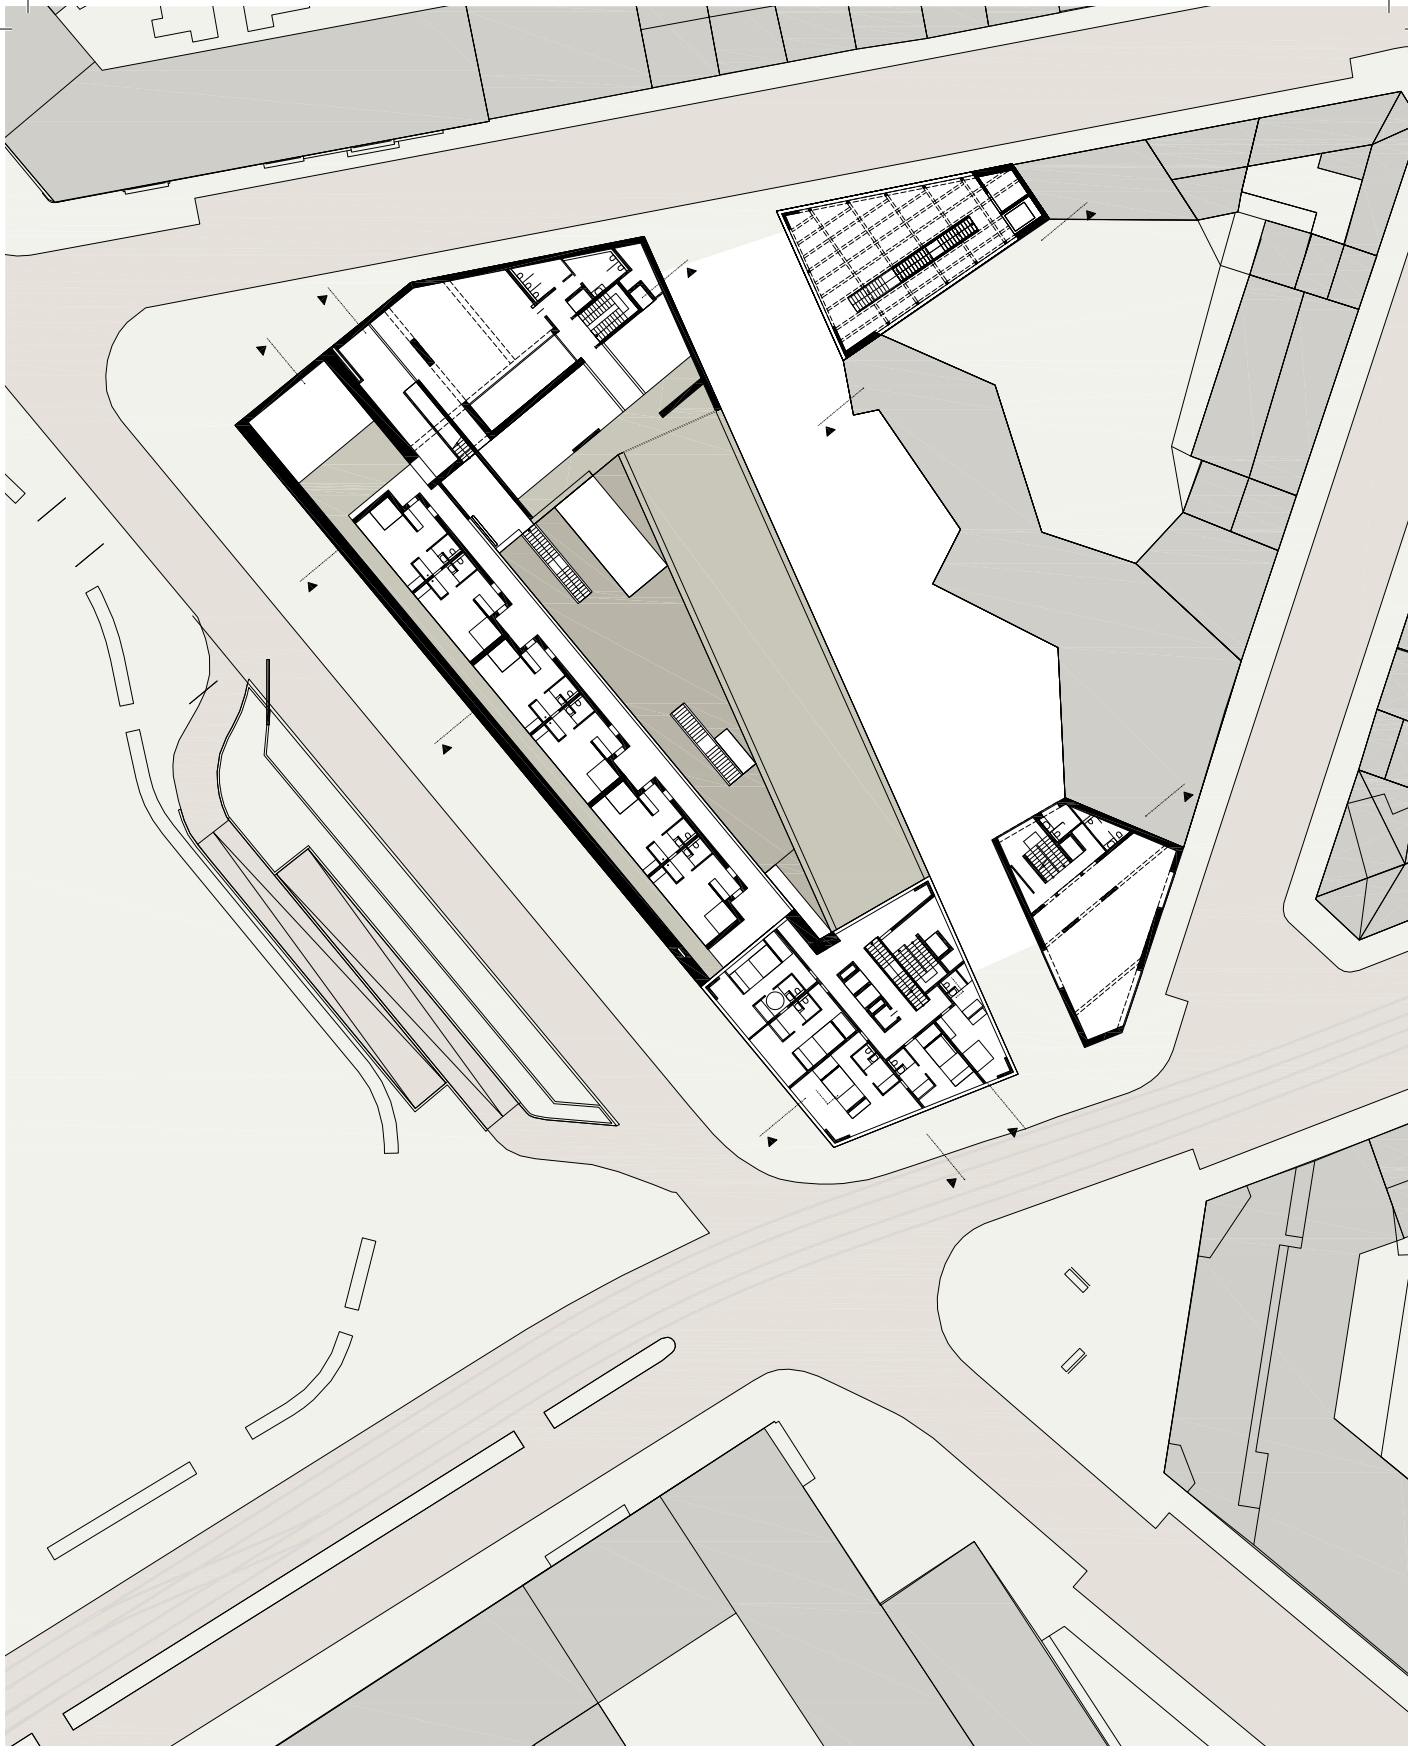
Grundrissplan 2.OG +11,70m
